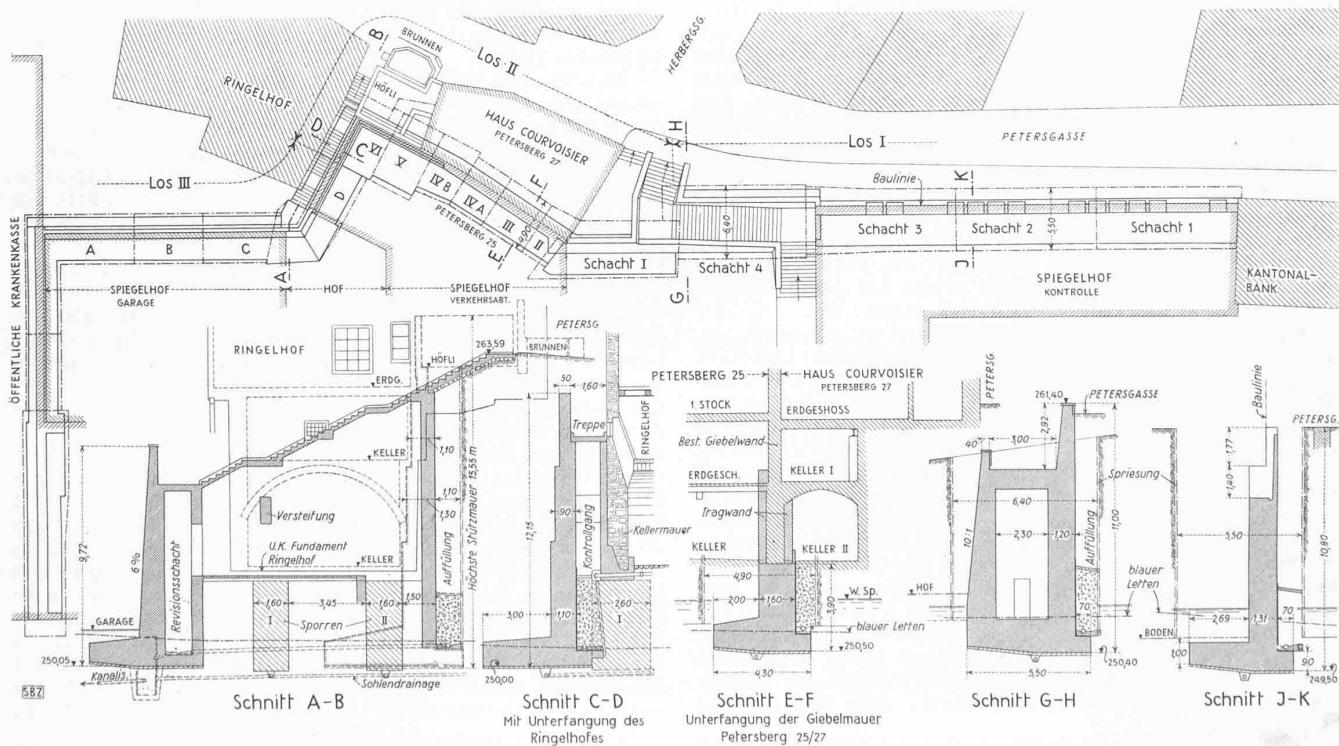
Grundriss (1:600) und Schnitte (1:300) der bergseitigen Fundamente und Stützmauern an der Petersgasse
